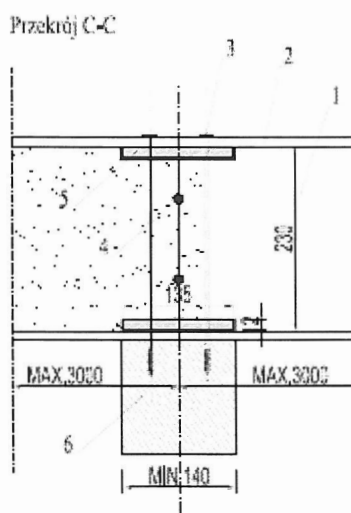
Przykładowe rozwiązanie dachu lub sufitu (stropu) z płyt LS-TECH
